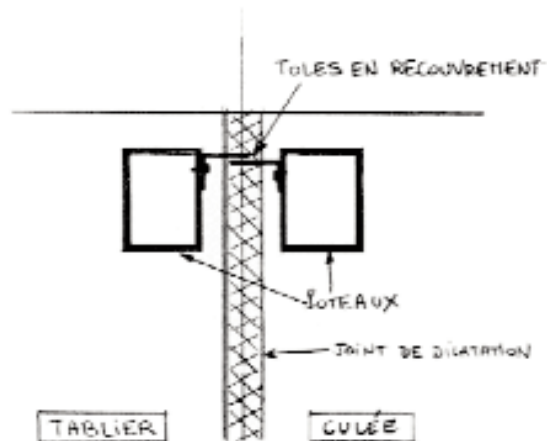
franchissement d'un joint de chaussée par un écran acoustique
